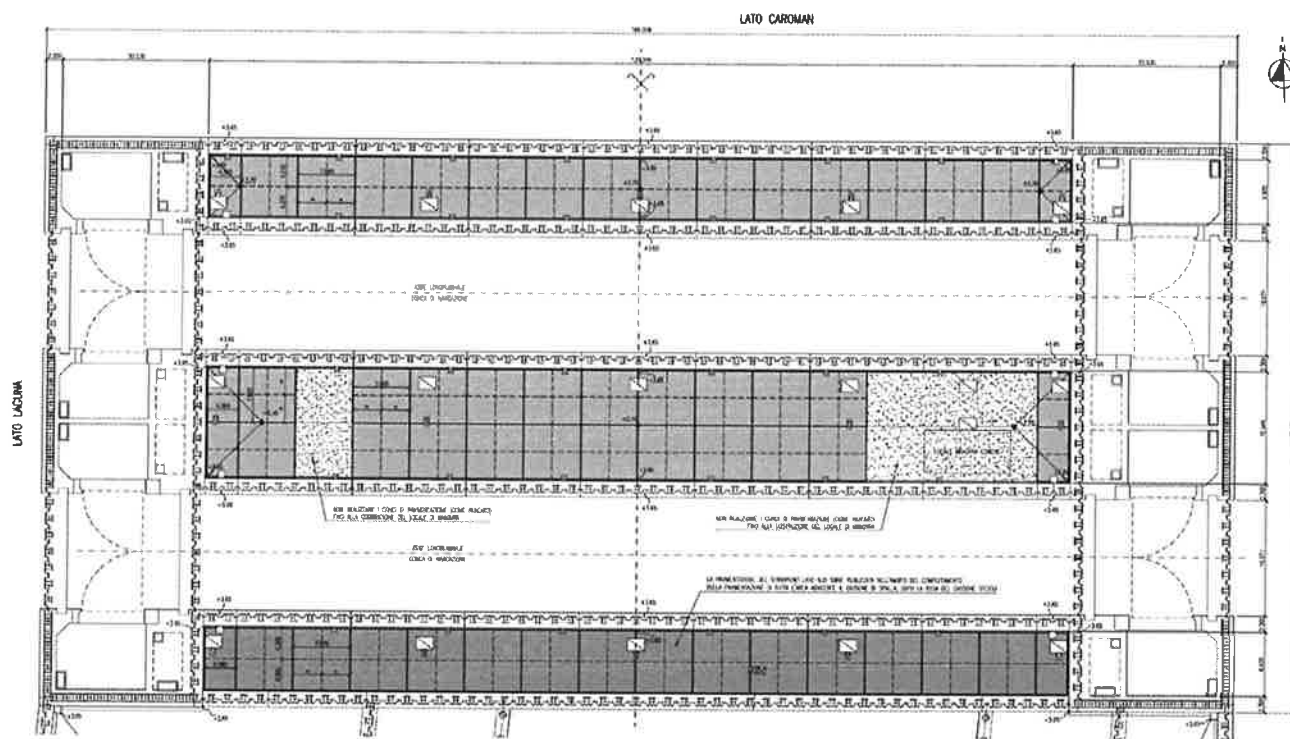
CONCHE DI CHIOGGIA – PLANIMETRIA DELLE CONCHE – STATO DI FATTO AL TERMINE DELLA WBS CH.E1.10
